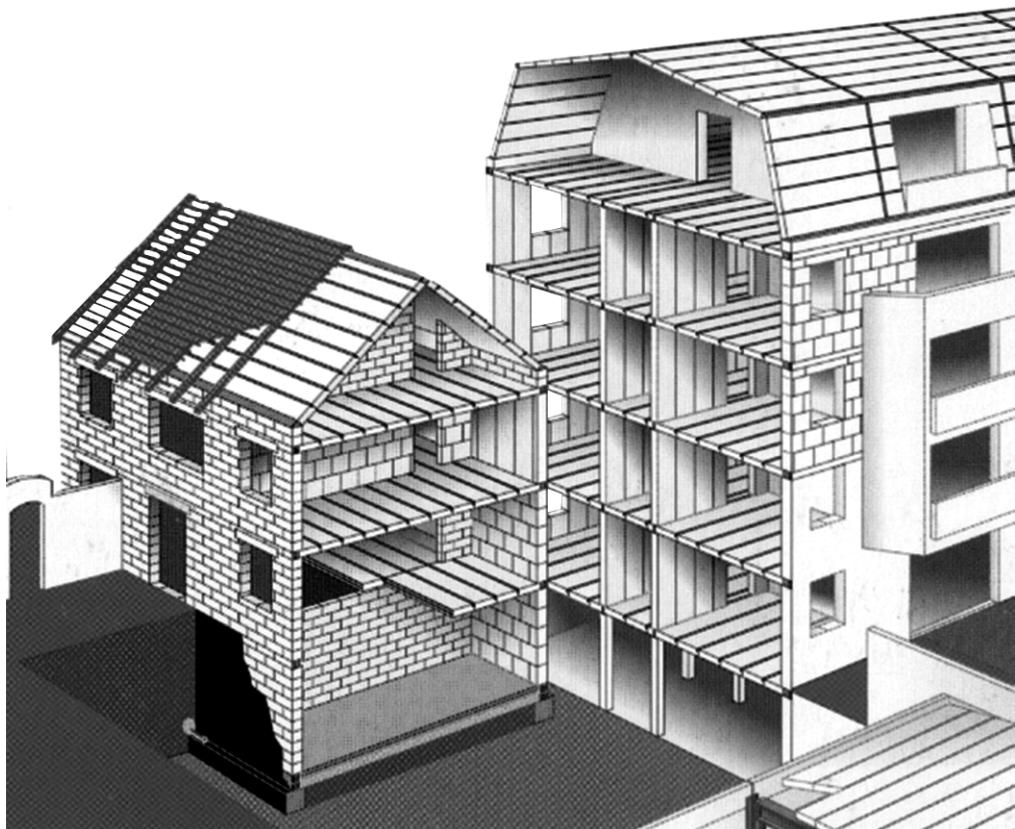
Схемы домов с мансардными и газобетонными перекрытиями (настилами)
